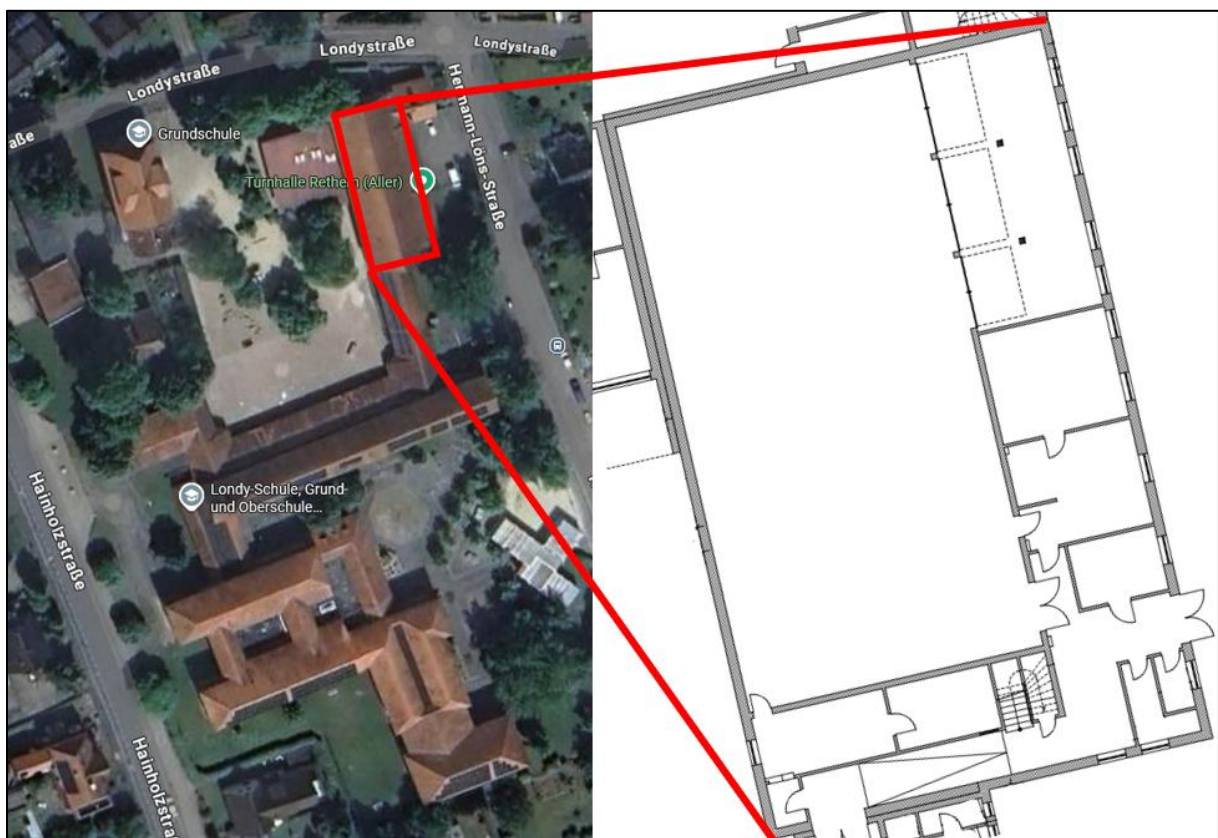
Luftbildausschnitt (Google Maps) mit Grundriss, Illustration
